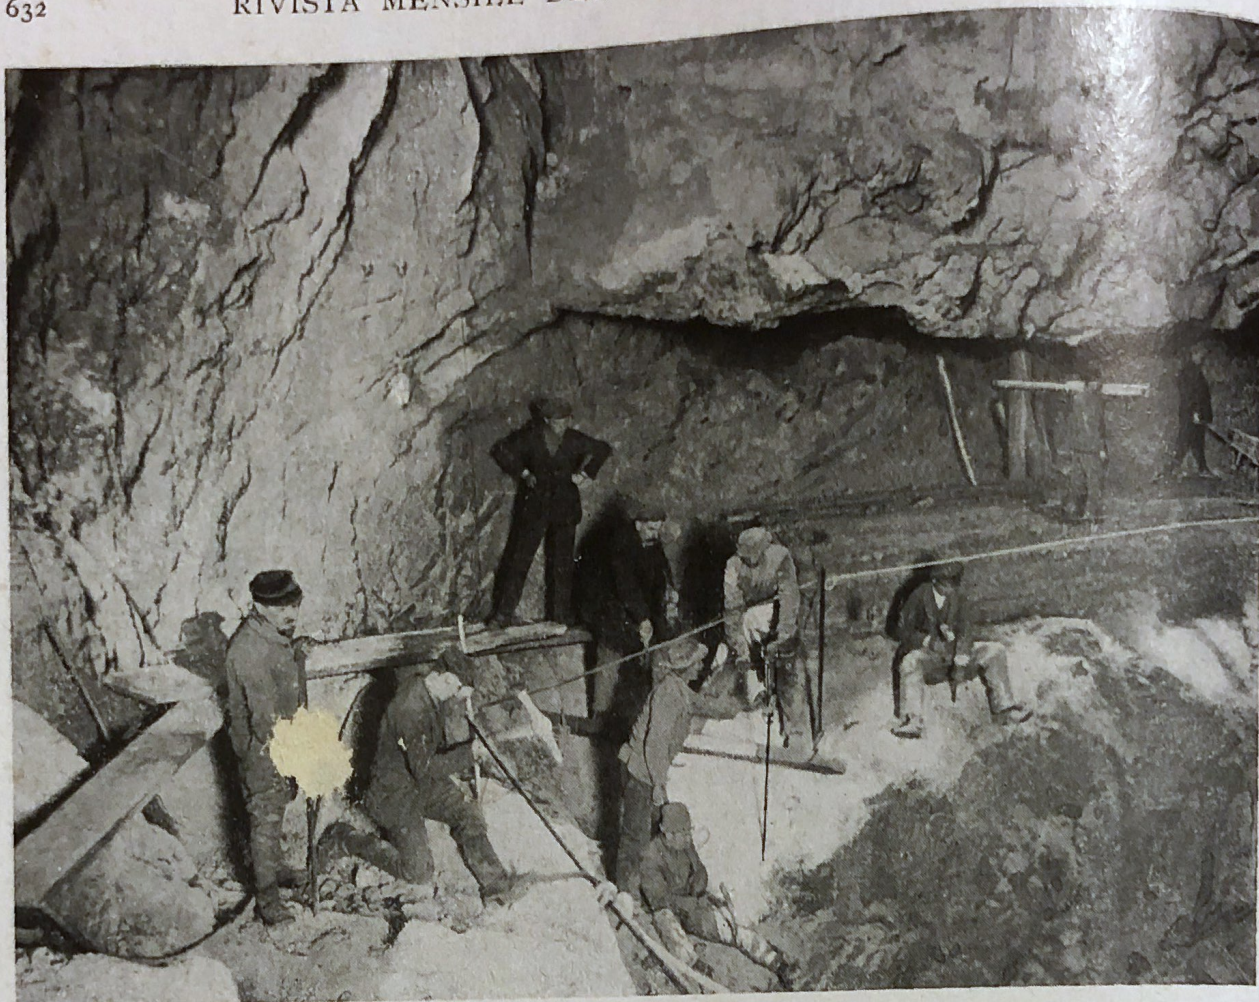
FIG. II - L'IMPOSTAZIONE SULL'ABISSO DI UNA SPALLA DEL PONTE DI CEMENTO ARMATO.
